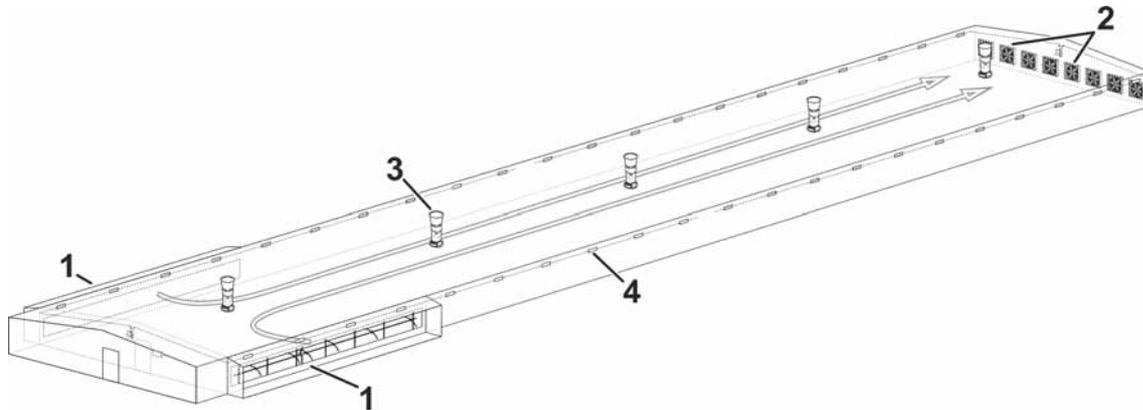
Exemple pour un système de ventilation (ventilation tunnel)
